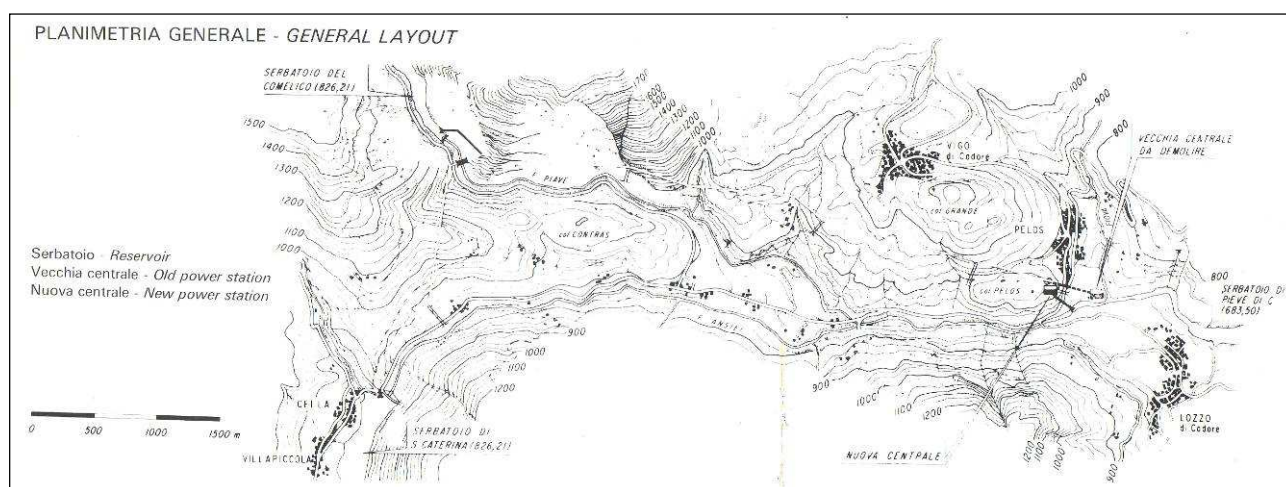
planimetria generale della nuova centrale ENEL, in caverna, e della vecchia centrale oggetto di intervento
